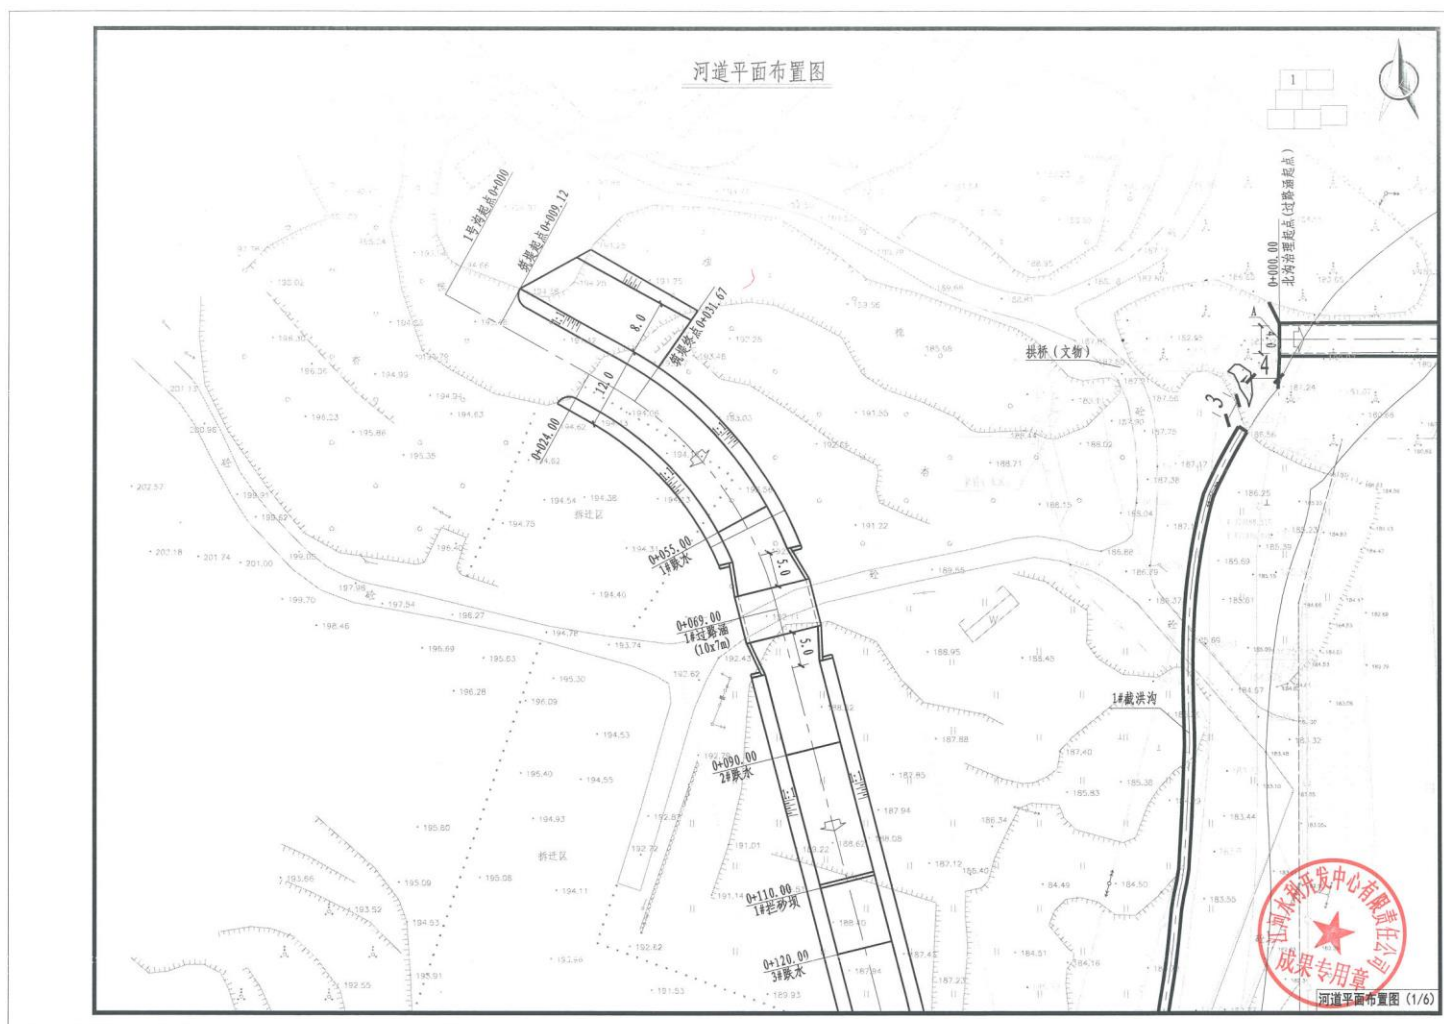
项目 1 号山洪沟和大工村北沟上段平面图
